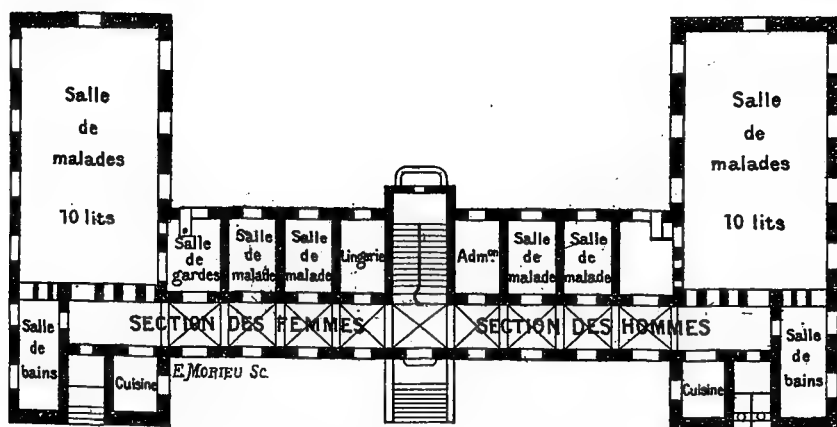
Plan du pavillon d'isolement à l'Hôpital municipal de Francfort-sur-le-Mein.
